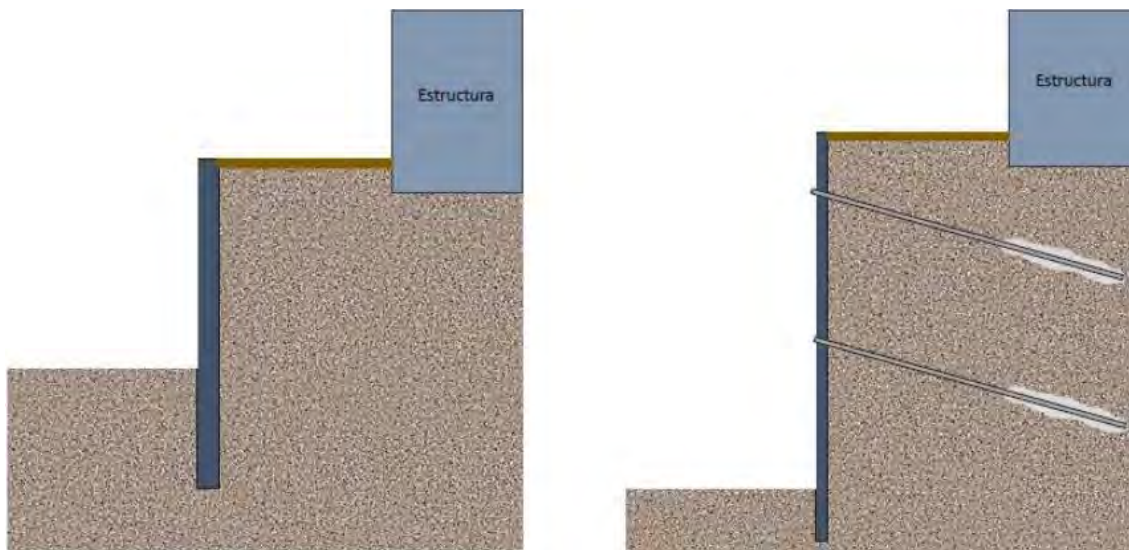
Tipos de muro pantalla por su forma de trabajo. Fuente: Propia
